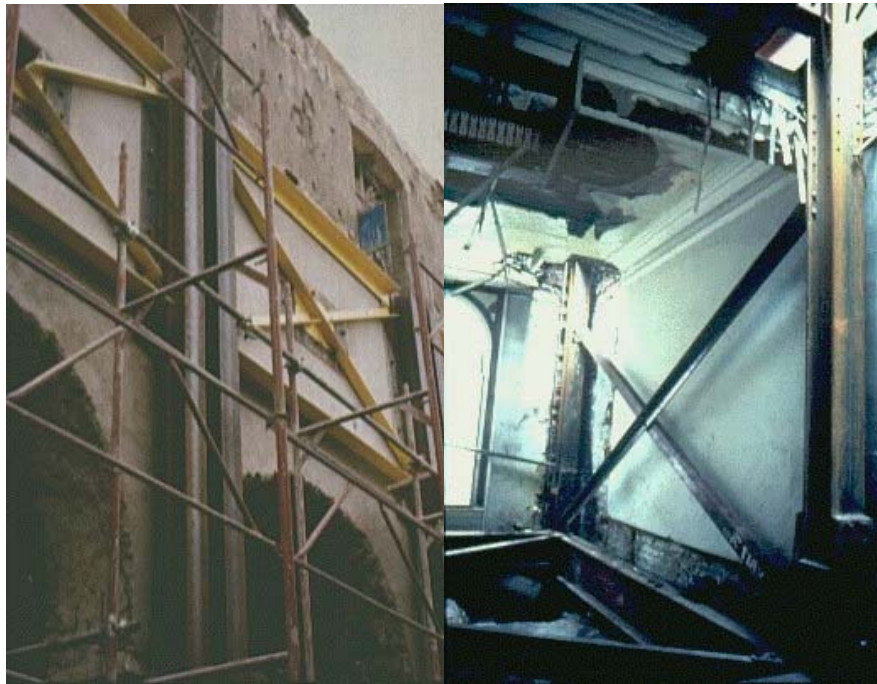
Travamento de fachada e no interior do edifício (Fonte: www.estg.ipleiria.pt)
